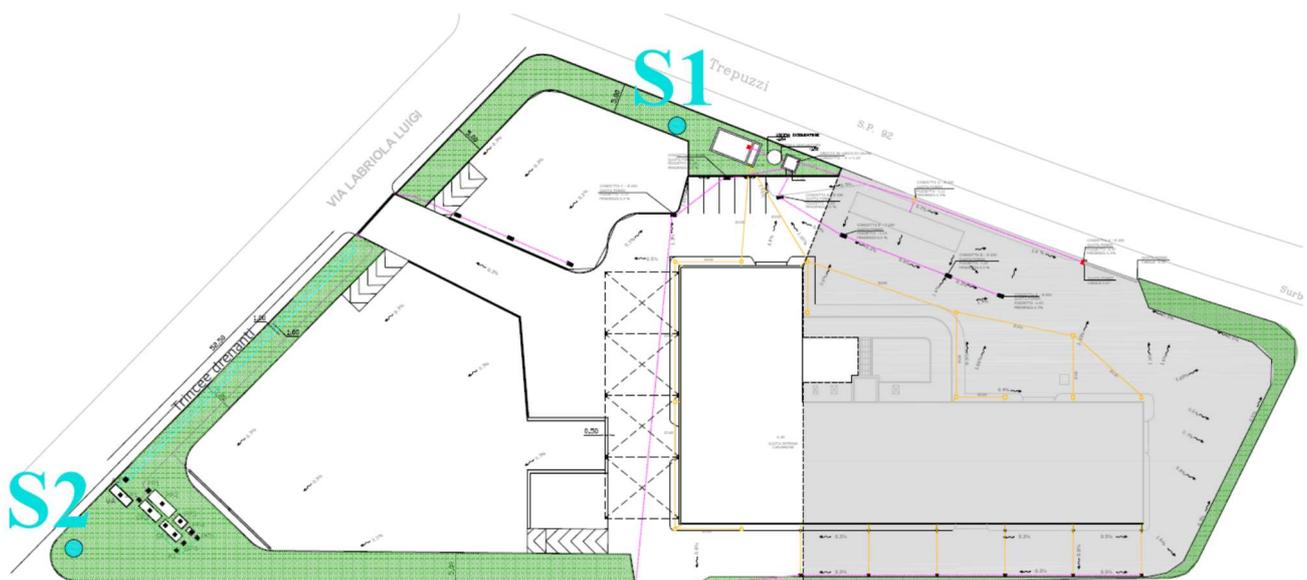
Localizzazione dei punti di campionamento rispetto alle Trincee drenanti ed alle Vasche di stoccaggio.
